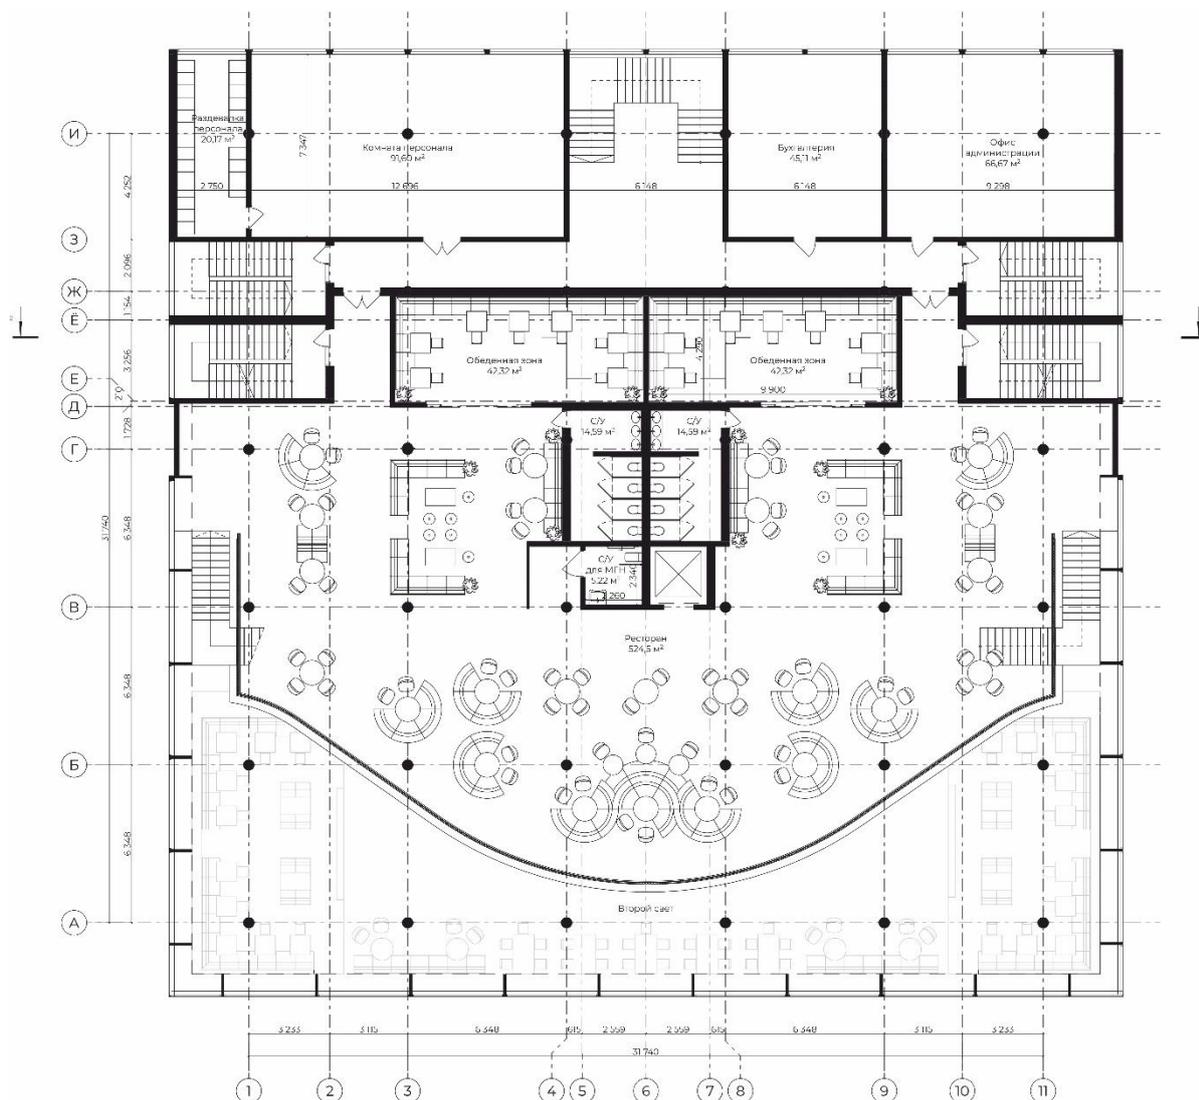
План второго этажа ресторана (29 этаж здания)
